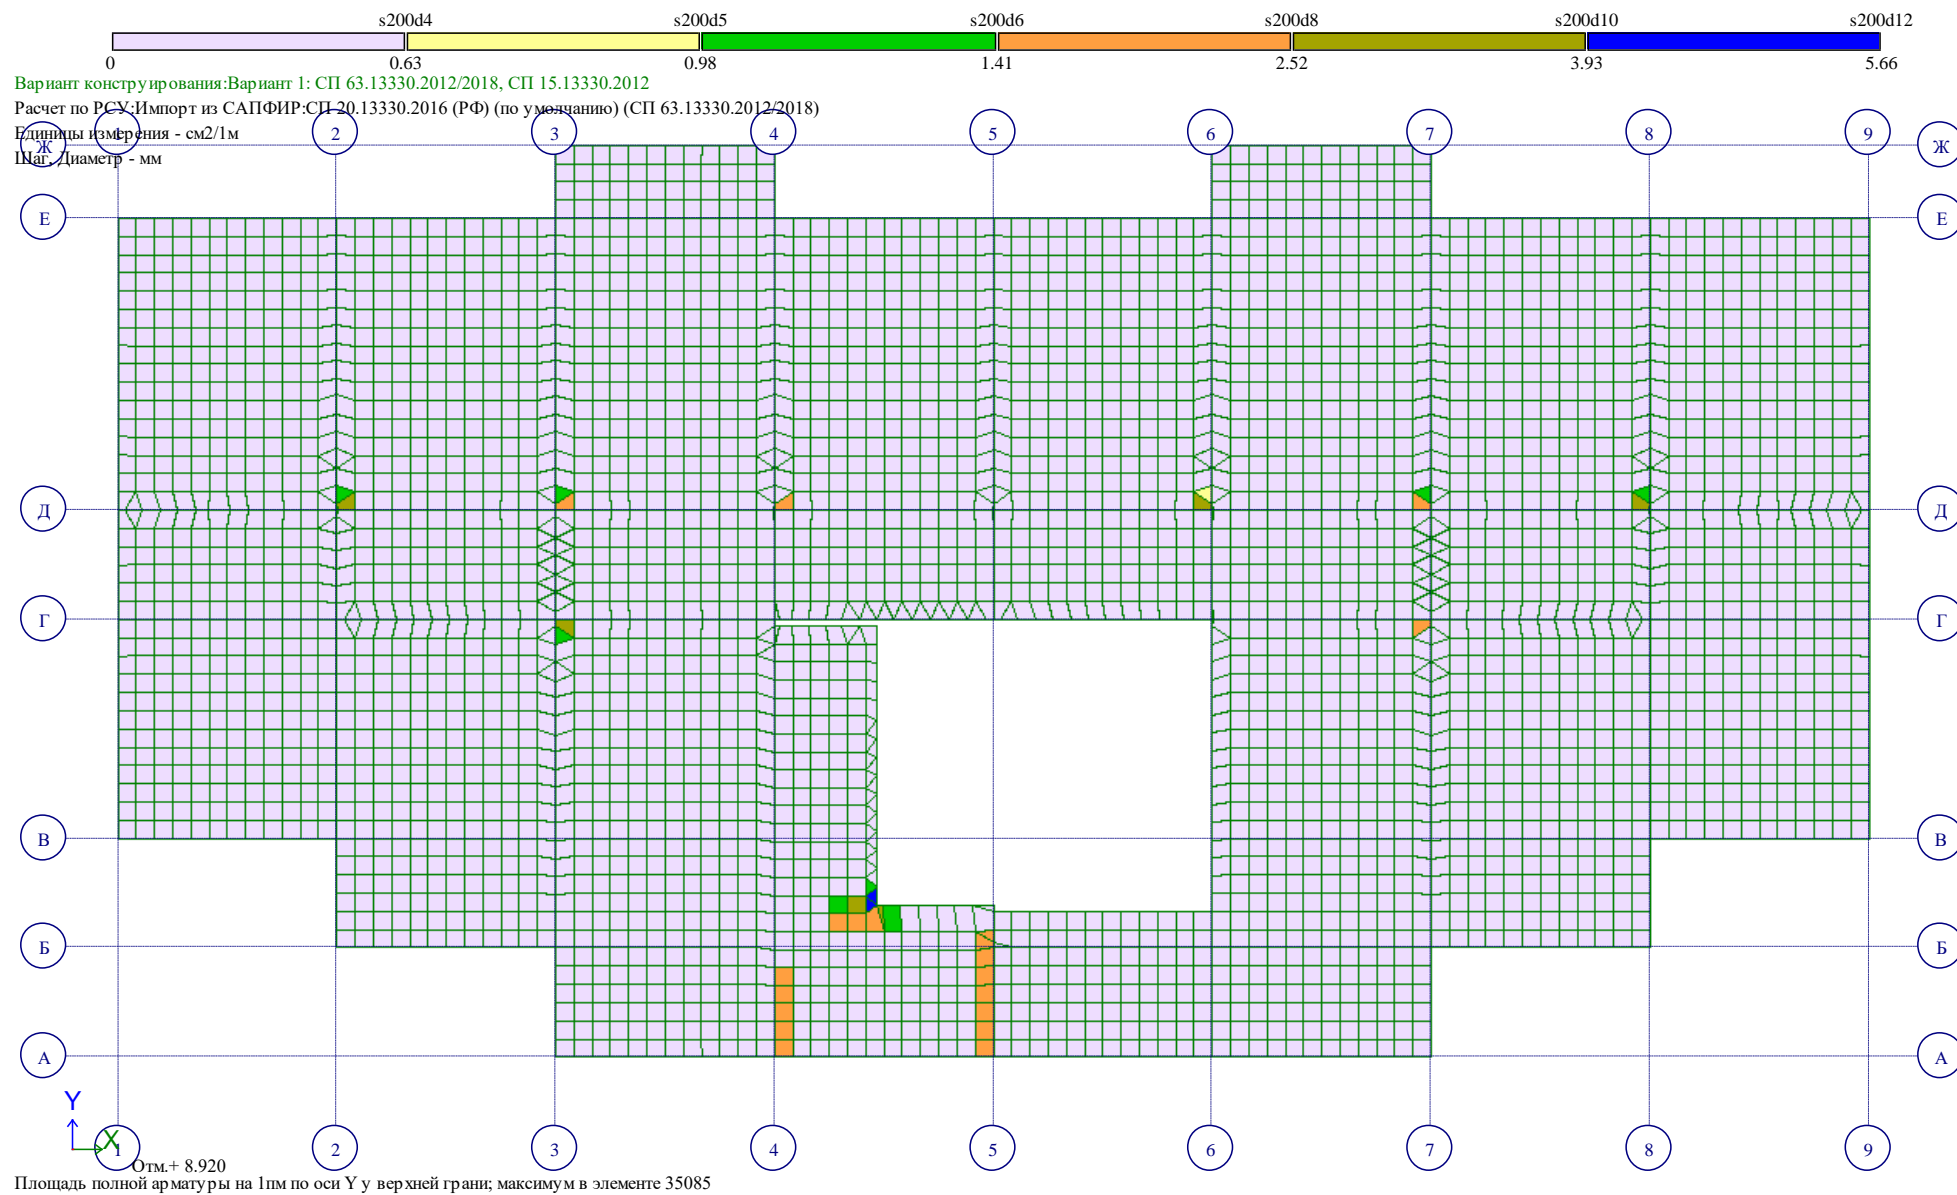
Площадь полной арматуры на 1мм по оси Y у верхней грани
